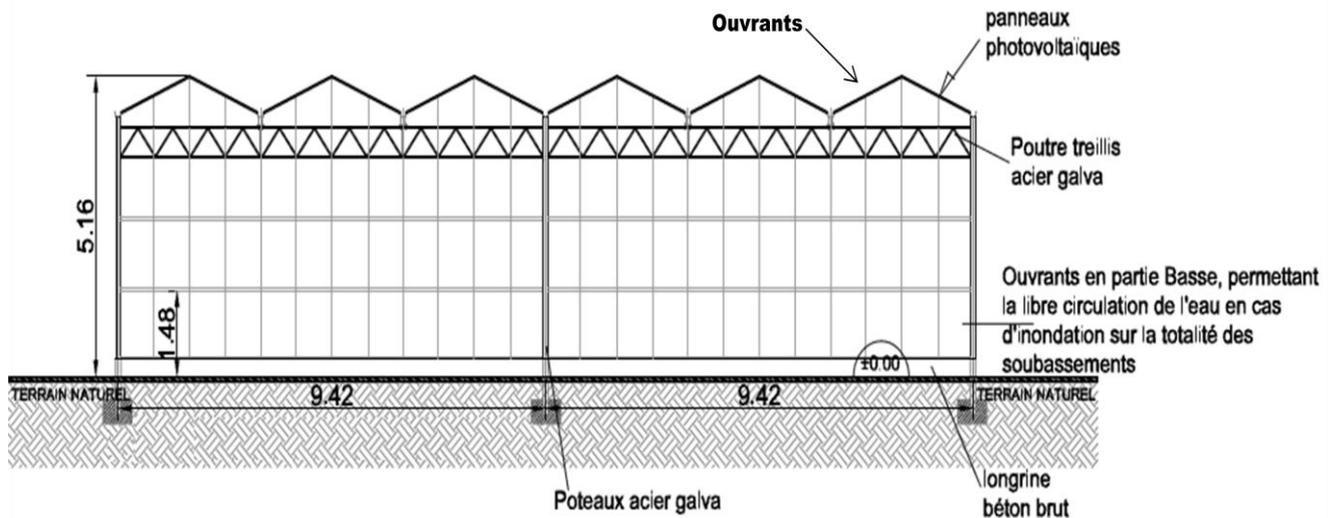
Coupe type serre multi-chapelles, côté pignon
